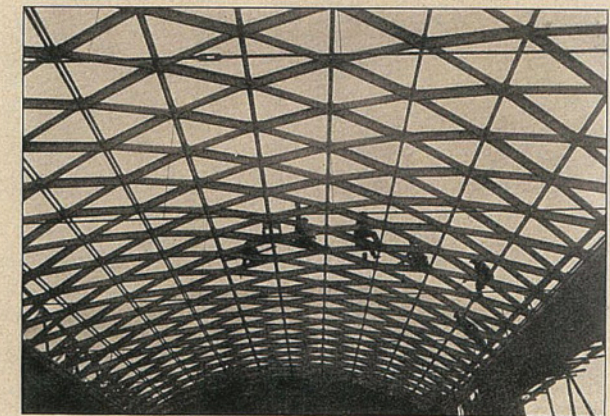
Montage einer Tragkonstruktion eines gebogenen Junkers-Daches.
